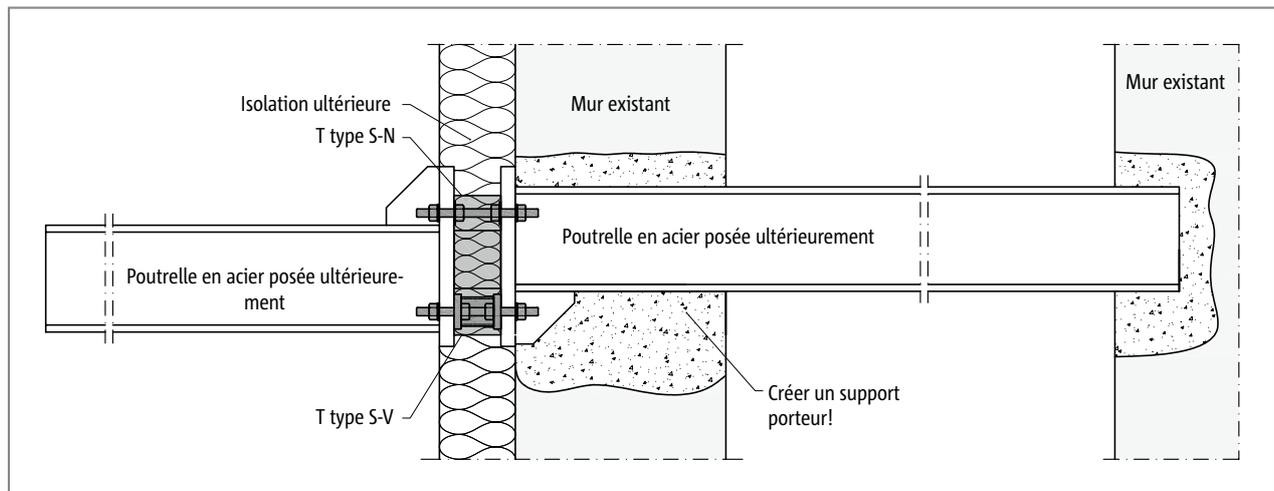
Schöck Isokorb® T type S-N et T type S-V : balcon en acier en porte-à-faux libre posé ultérieurement ; raccordé à des poutres en acier installées ultérieurement avec décalage en hauteur
